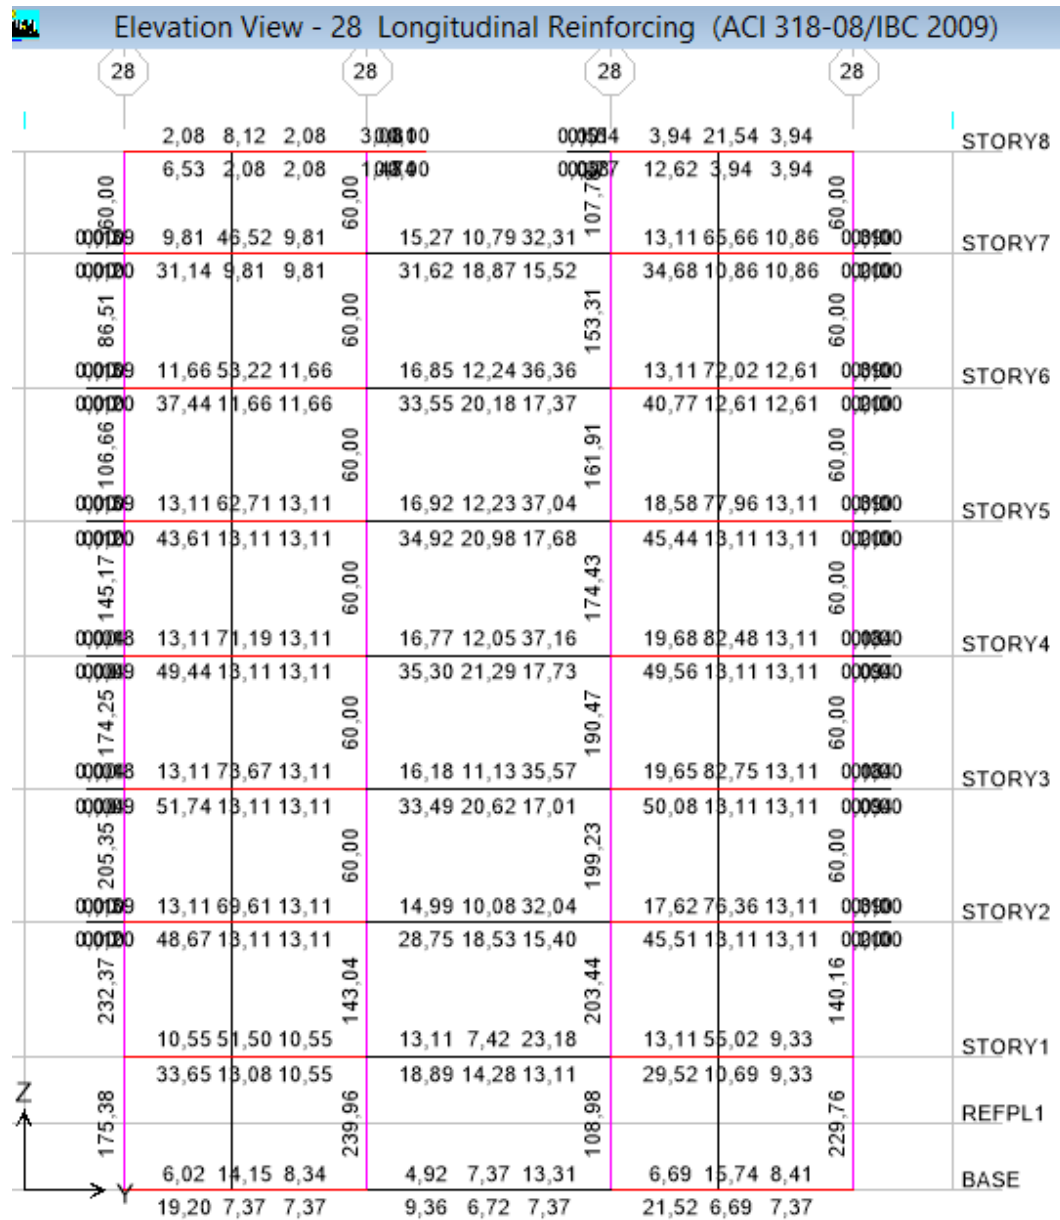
Acero en Vigas y Columnas en el Pórtico 28 – Hospitalización 2- (LRB+HDR)
